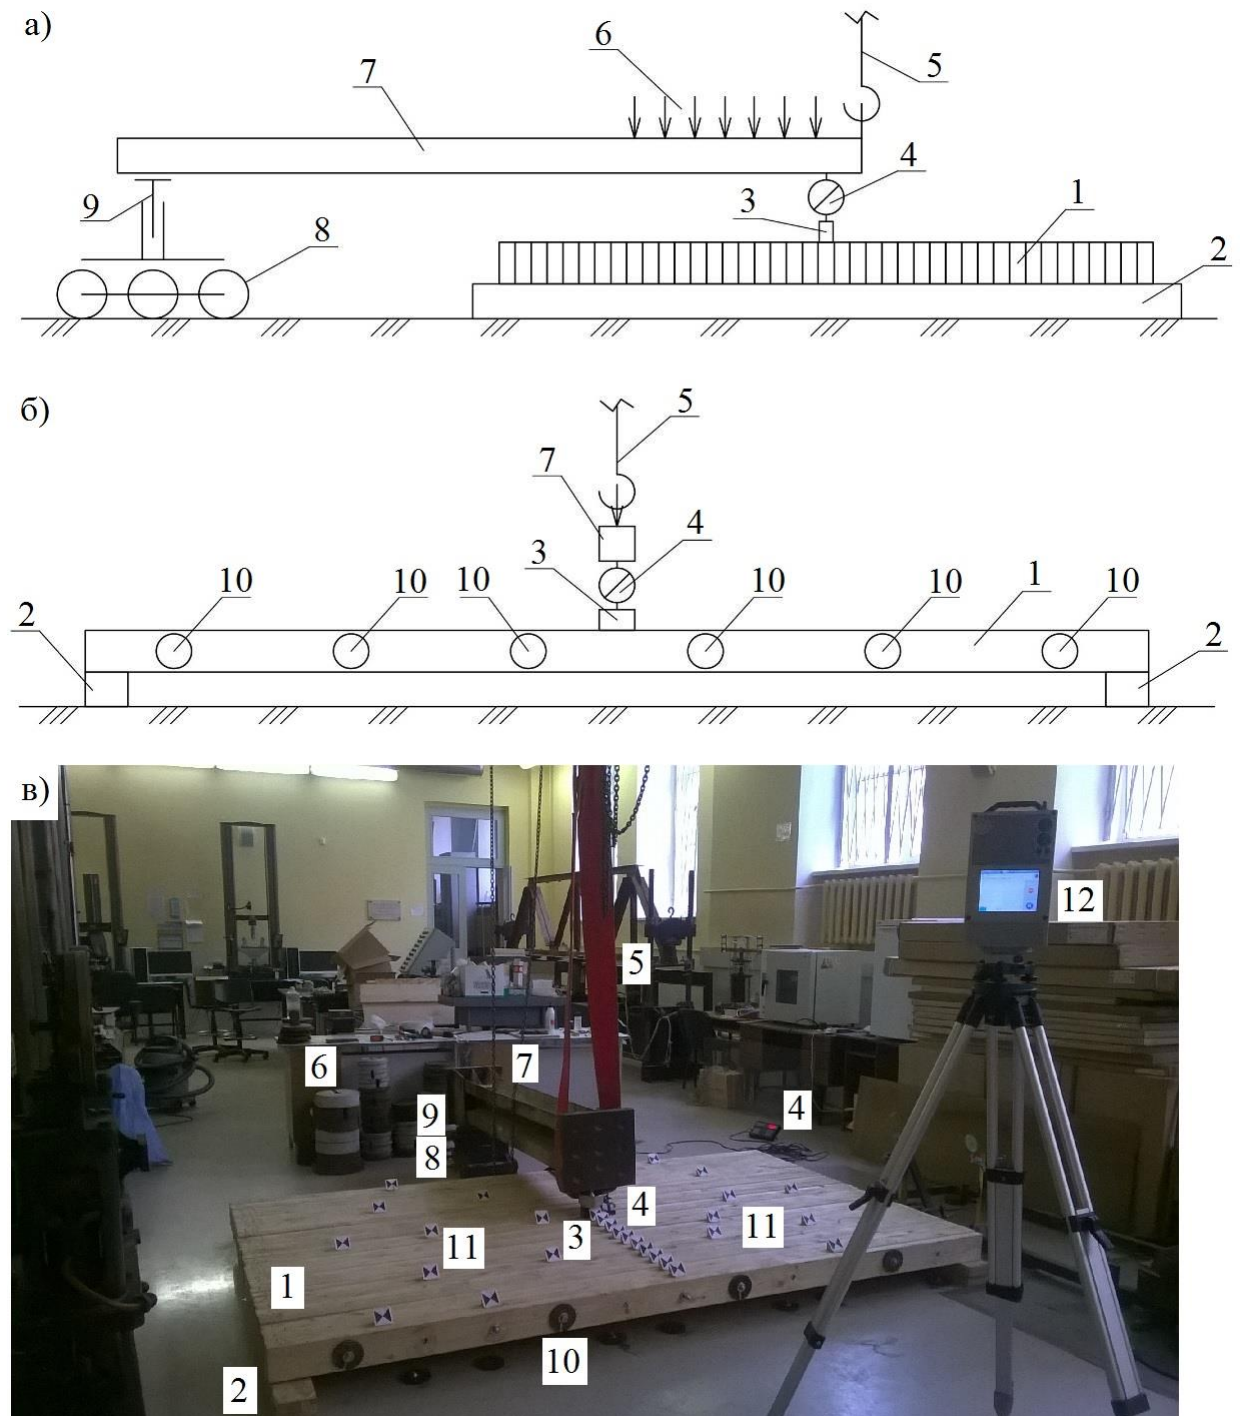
Схема испытательной установки: а) профиль; б) вид спереди; в) общий вид установки в сборе;
